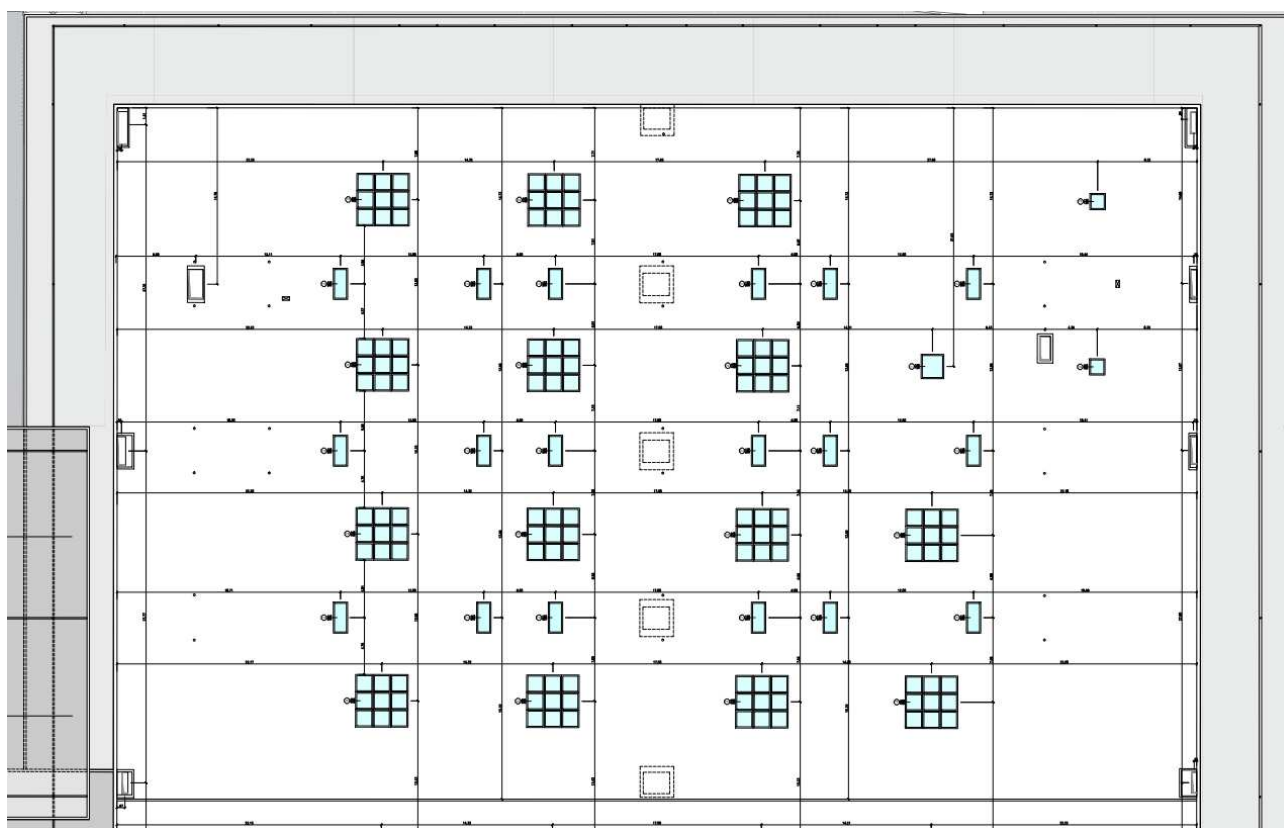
Planimetria progetto coperture fabbricato esistente.
